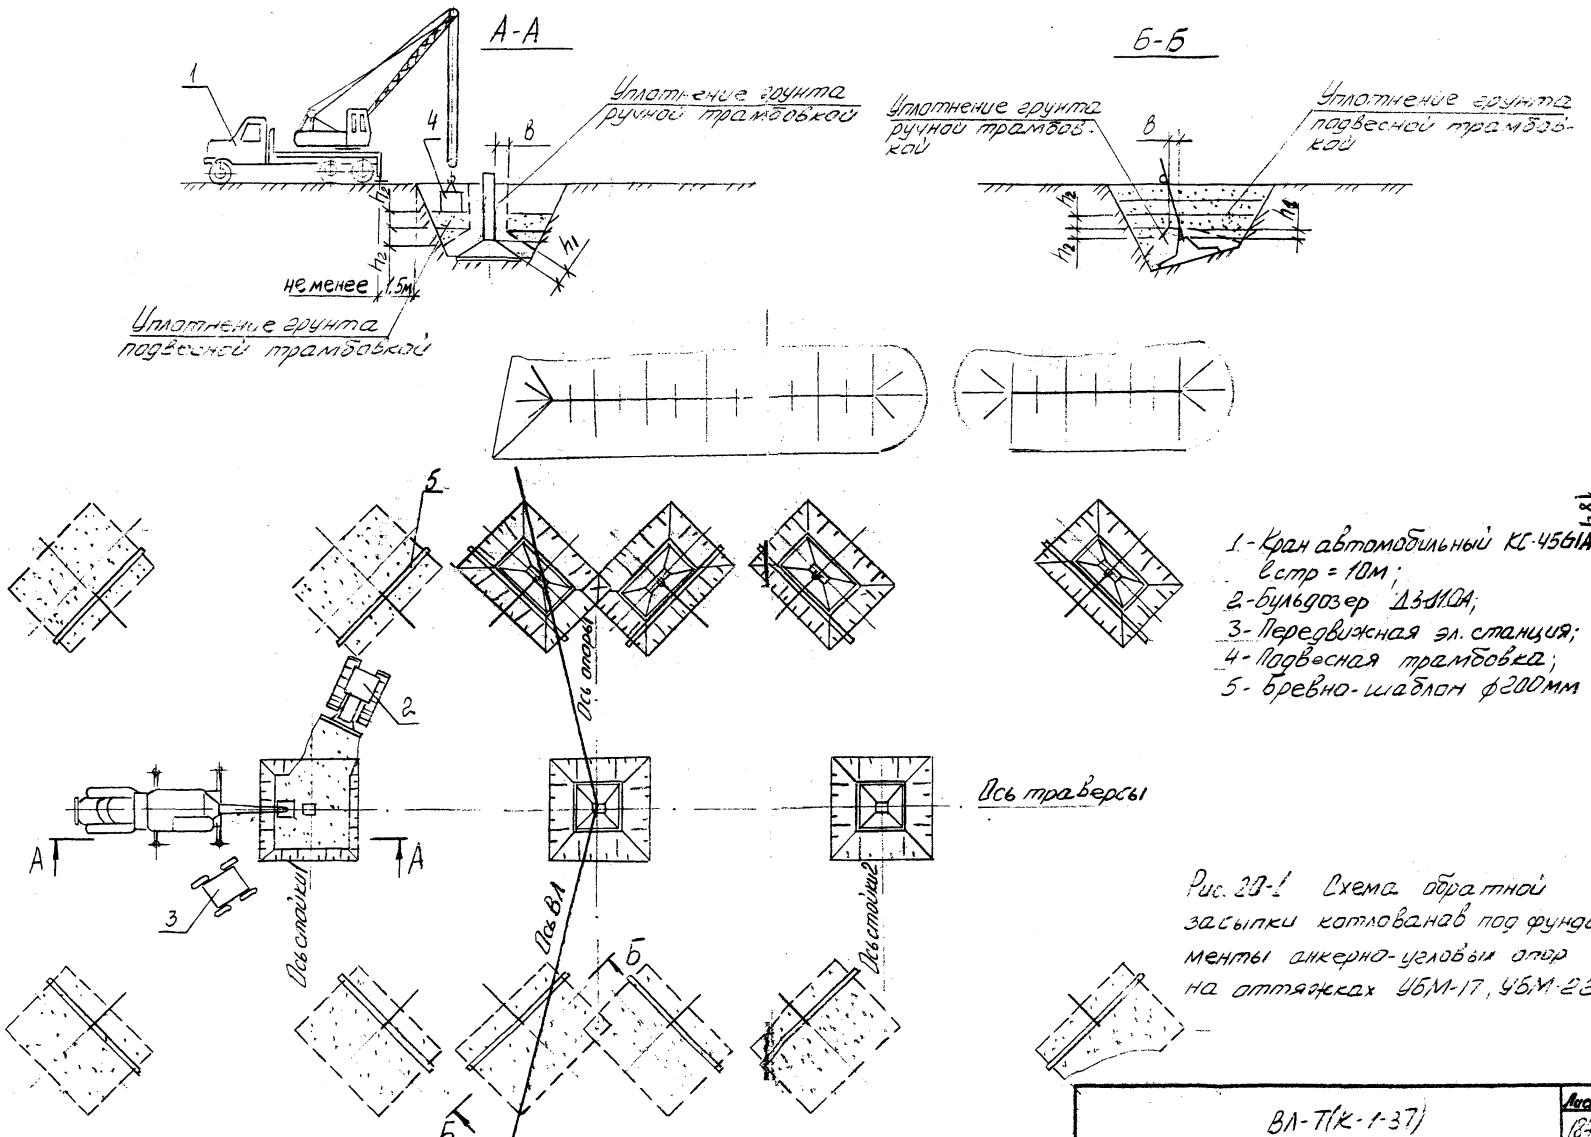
Схема обратной засыпки котлована под фундаменты анкерно-углубленных опор на оттяжках ЧБМ-17, ЧБМ-22
